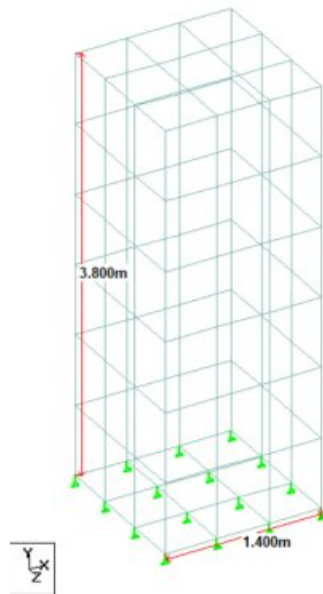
Modelado de la estructura en Staad Pro. Fuente: Elaboración propia.
